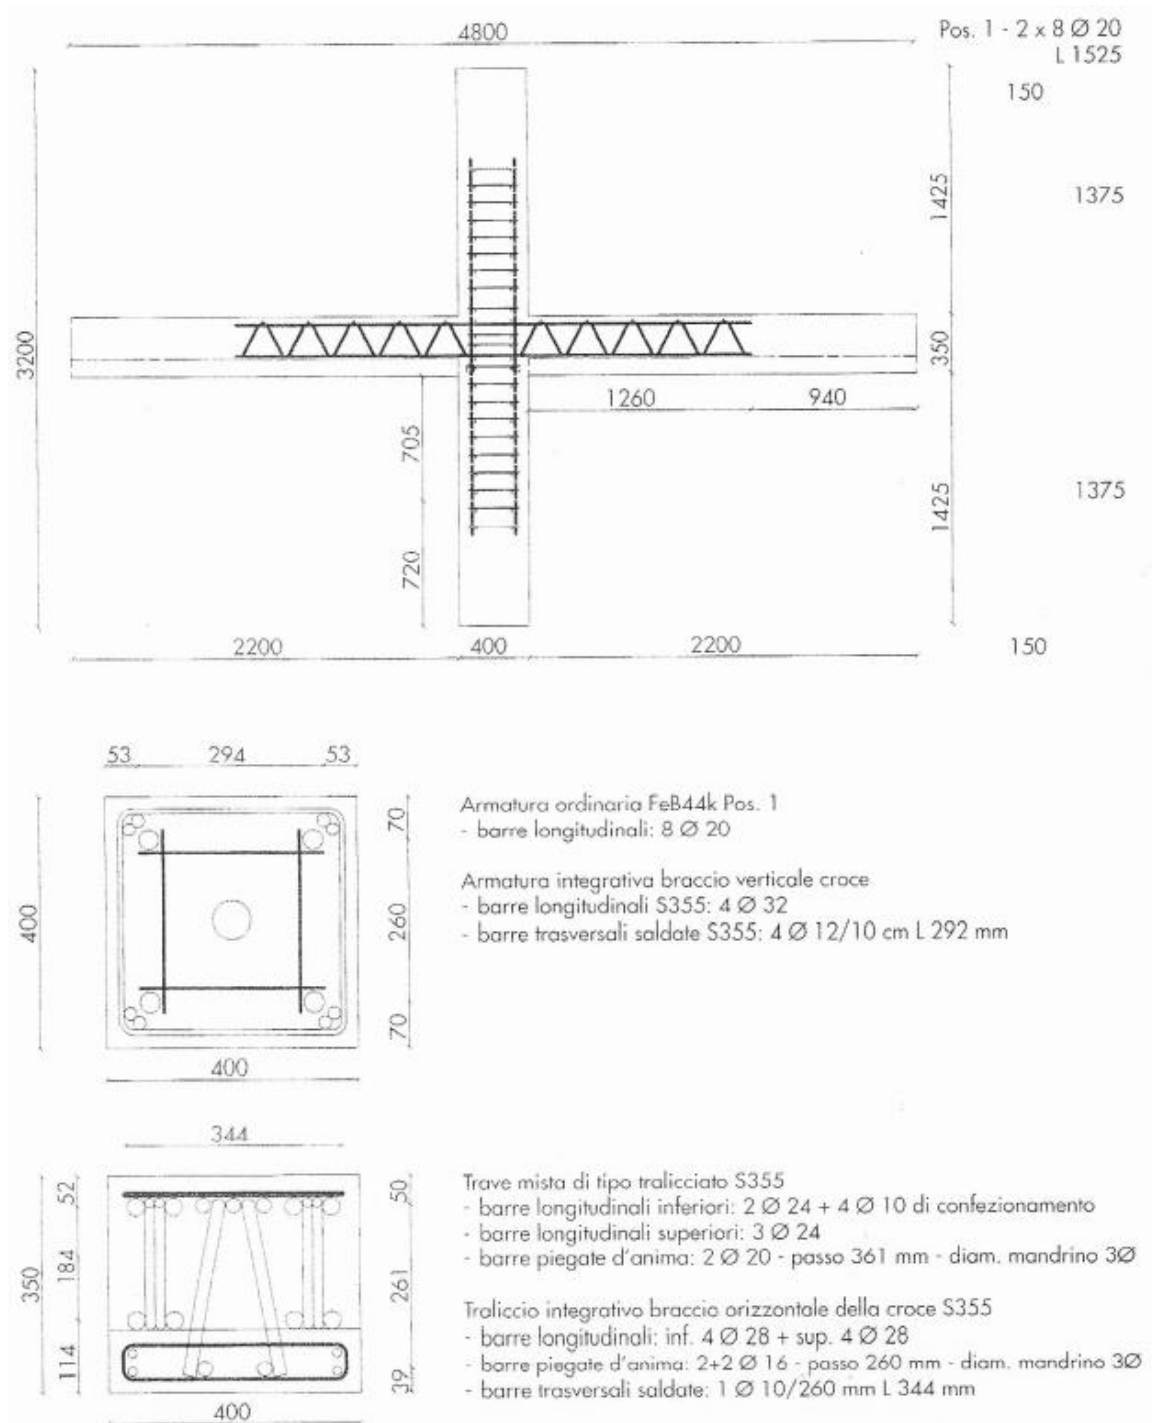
Dettagli armature del nodo con travi in struttura mista, pilastro in c.a. e traliccio integrativo a croce.
